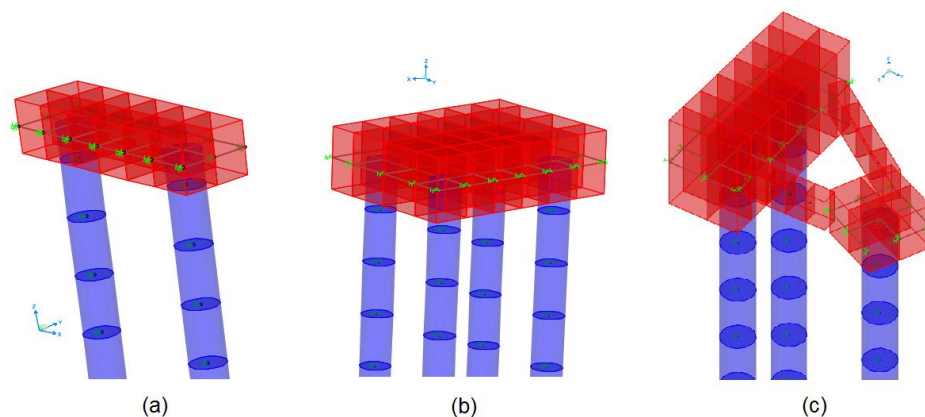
Vista tridimensional dos modelos das fundações: (a) pilar P1; (b) pilar P2; (c) encontro E2
